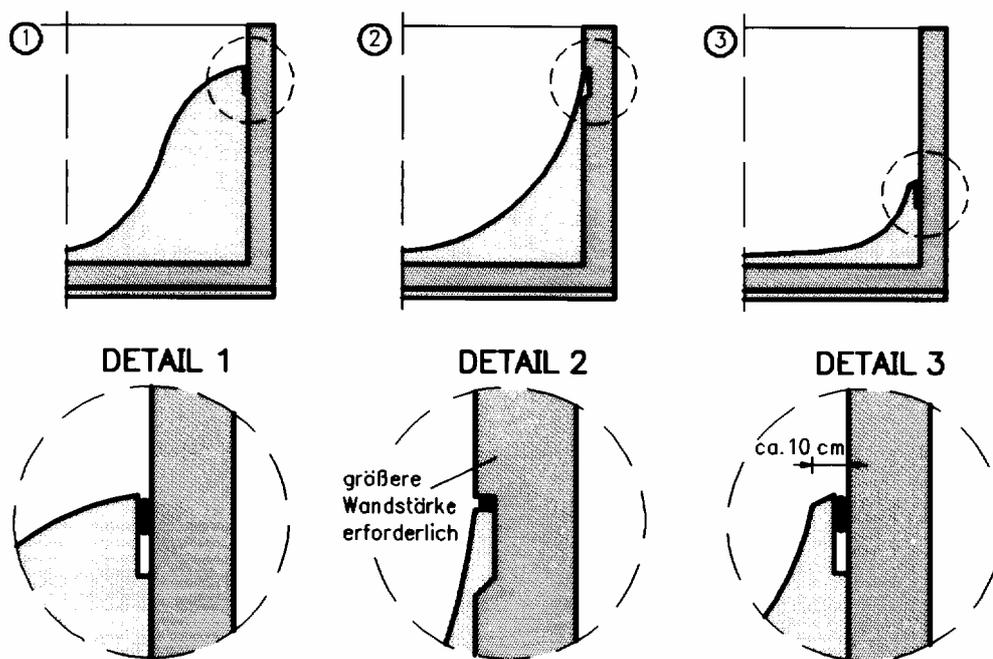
Beispiele für den Anschluß von Profilbeton an Wände
